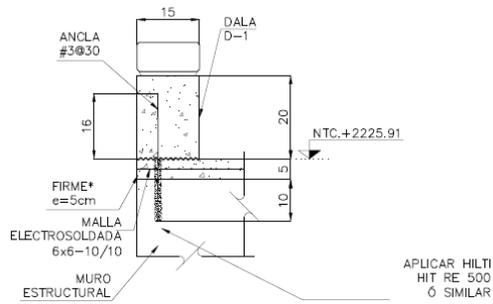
Anclaje de pozos de acceso, sobre muro estructural.
